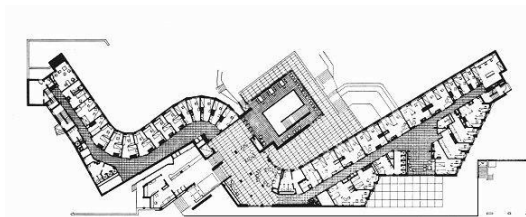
Planta da Baker House, Massachussets, E.U.A (Alvar Aalto, 1945-1947).
